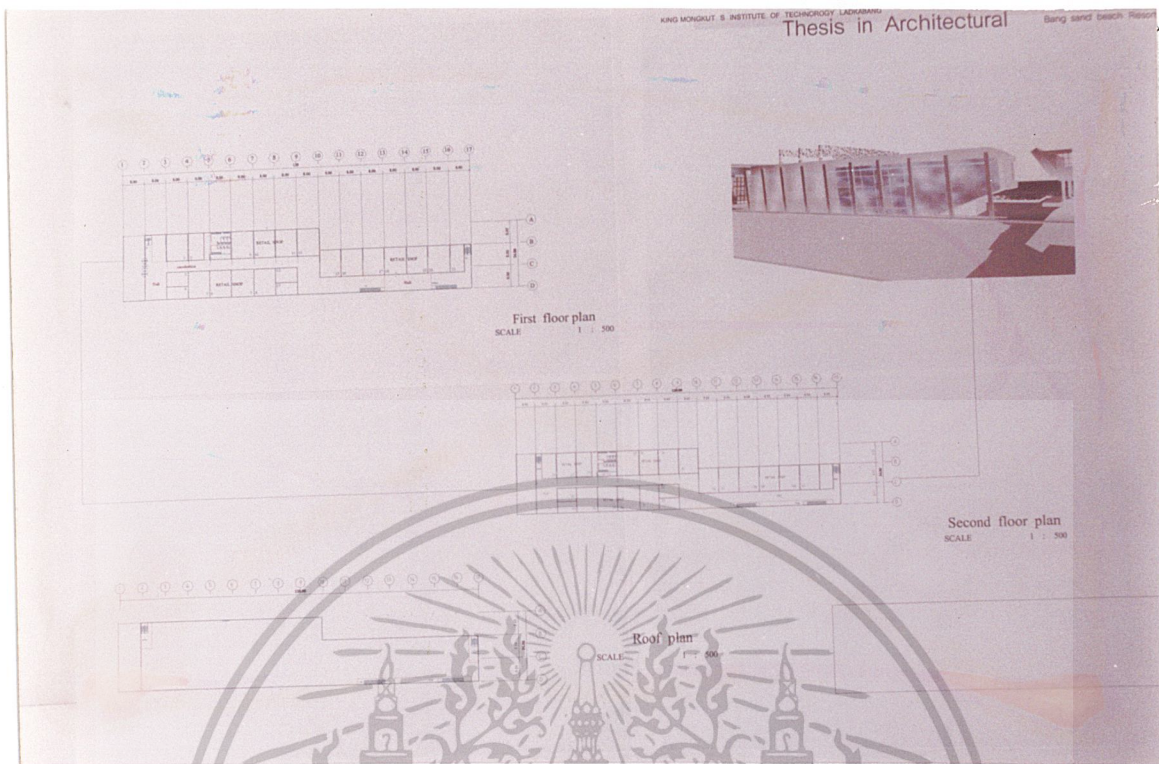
PLAN SHOPPING TYPE 1
